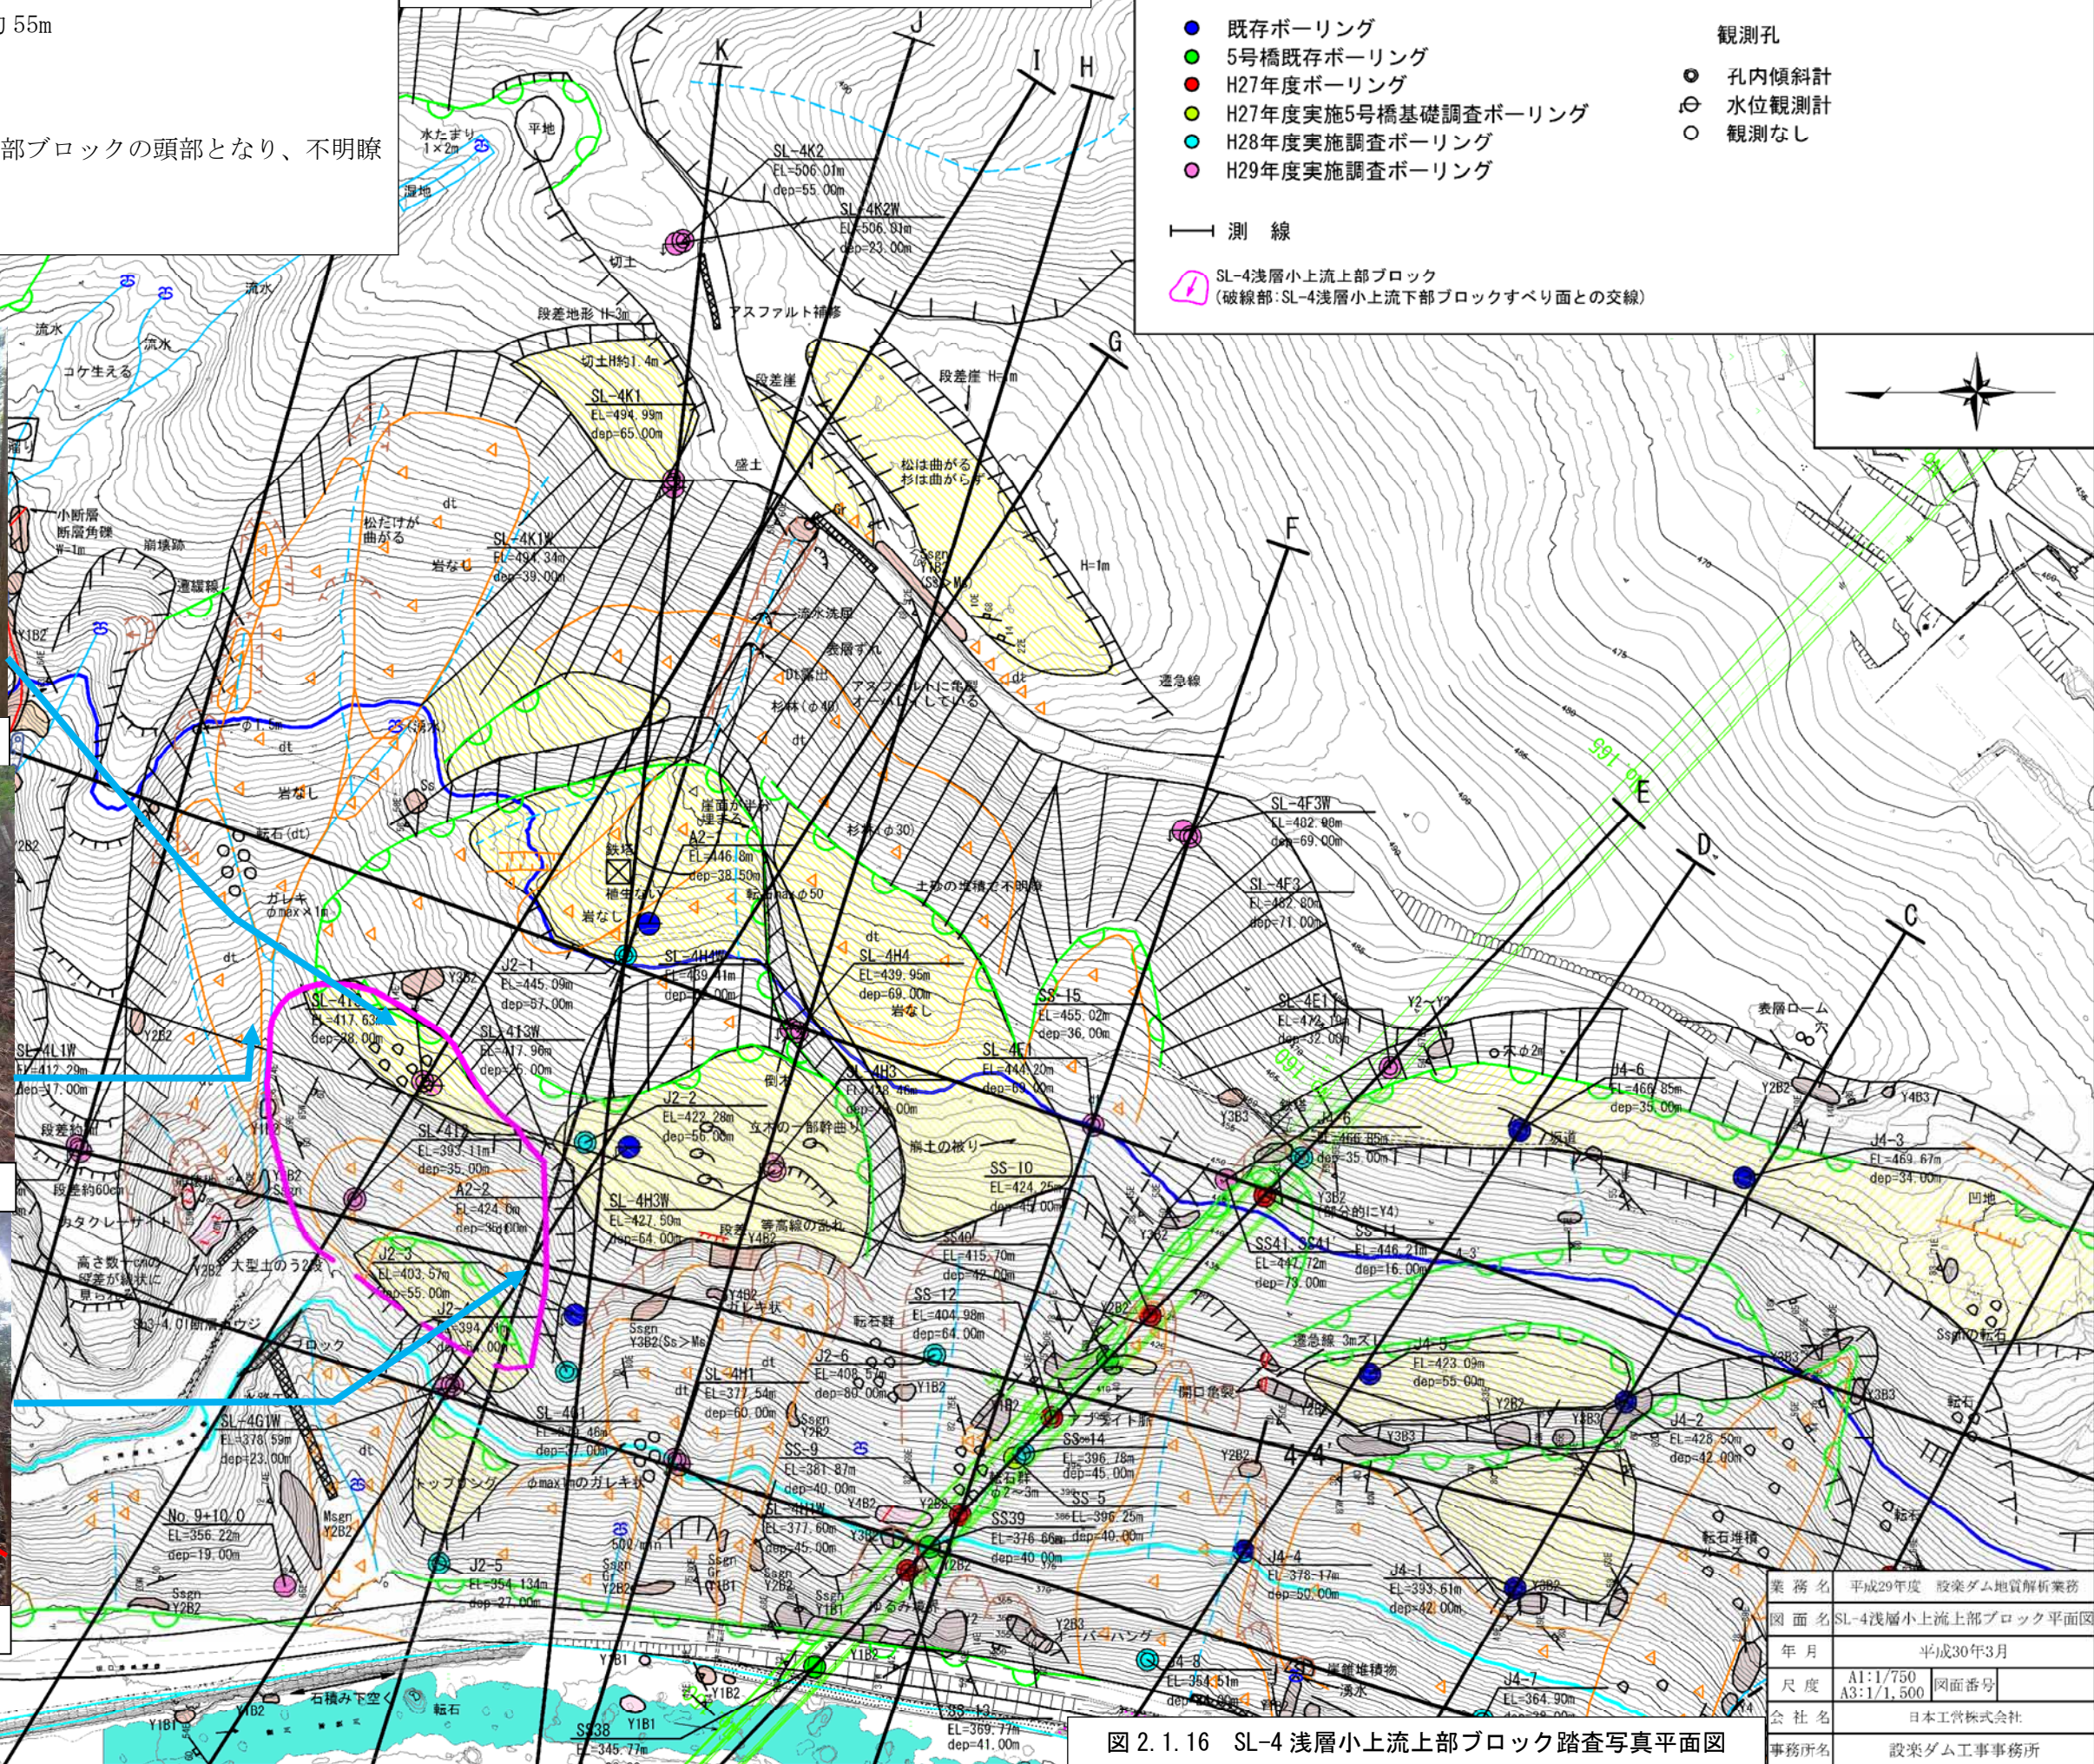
SL-4 浅層小上流上部ブロック踏査写真平面図
